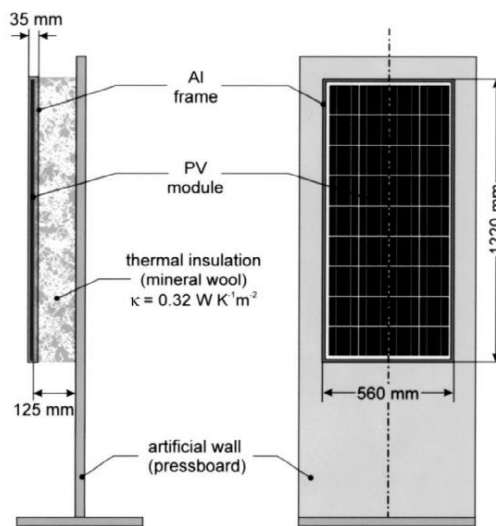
Vista lateral e frontal de um módulo fotovoltaico aplicado a fachada de edificações com ventilação.
